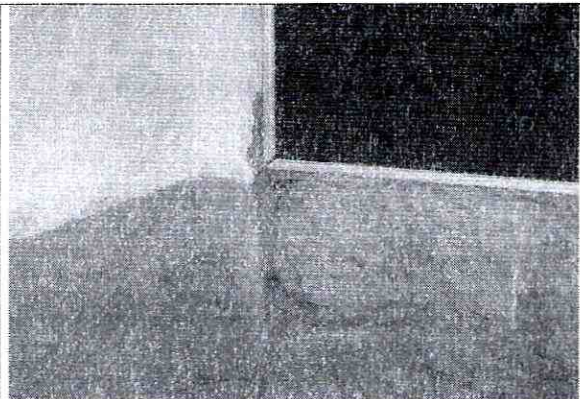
Humedad en el muro del costado oriental, salón de transición.
